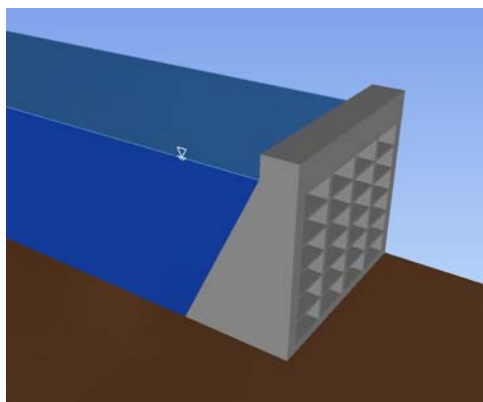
中空重力式コンクリートダムの概要 写真－3.2.2 中空重力式コンクリートダム
